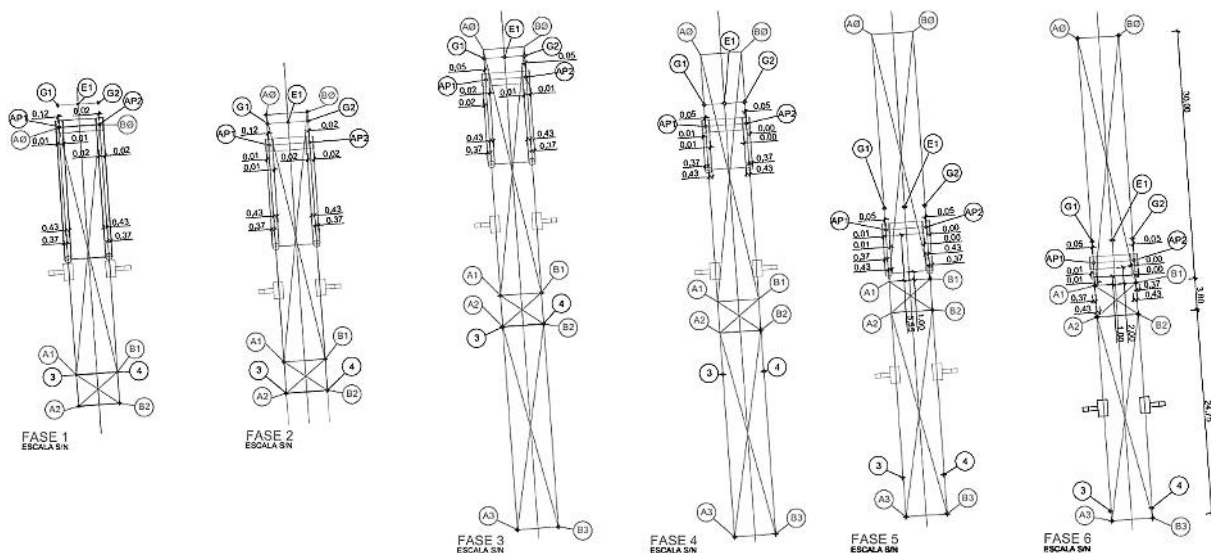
Replanteo en planta de puntos de control durante los primeros empujes.
